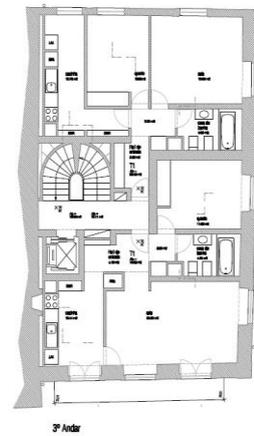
Planta de Arquitectura do 3º piso (tipo) proposta
